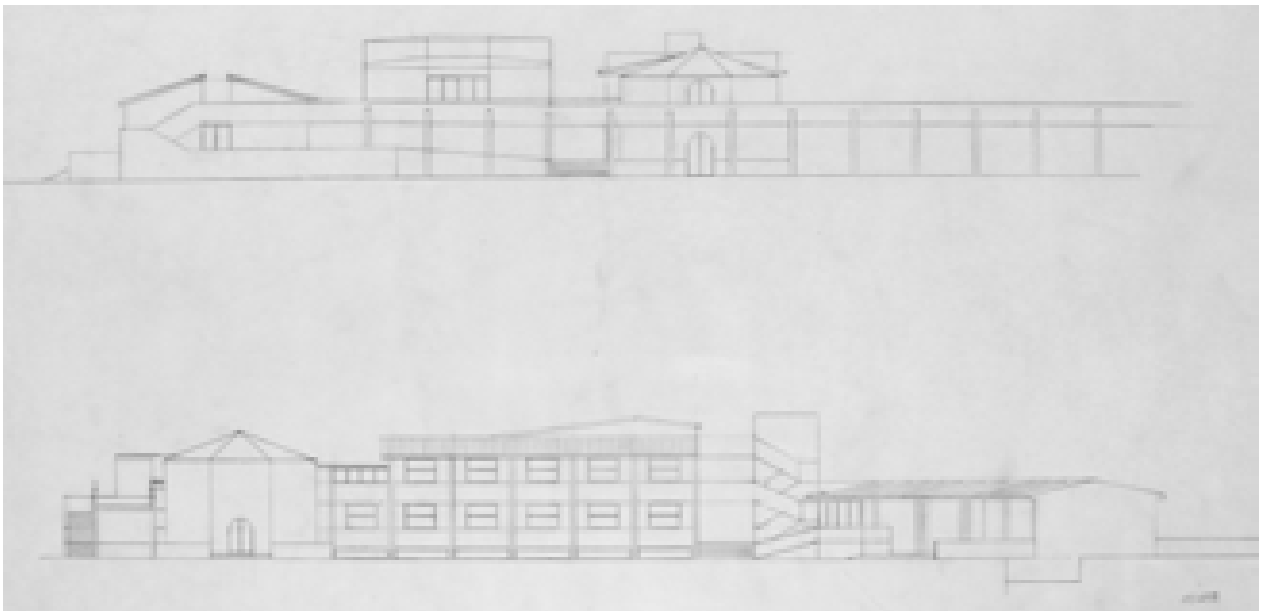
Prospetti Nord-Sud, stato futuro – 11/07/1989 (AABS-64_473)
